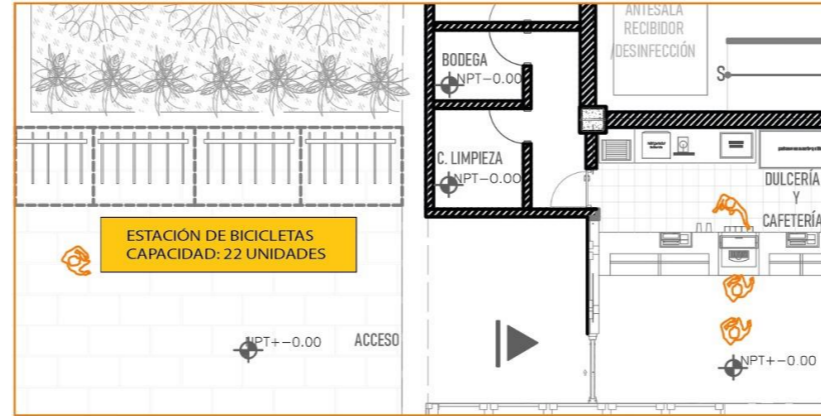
Extracto de planta arquitectónica donde se ubica una estación de bicicletas
